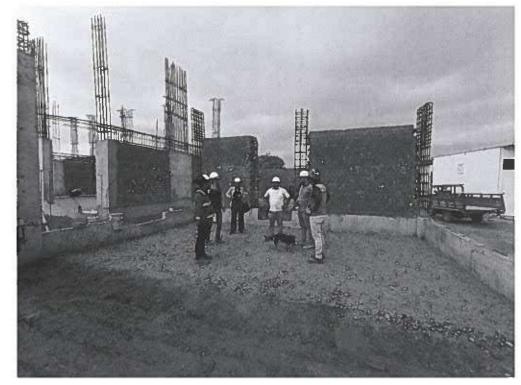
Se verifica los trabajos de vaciado de concreto para falso piso del bloque N.º 08.
